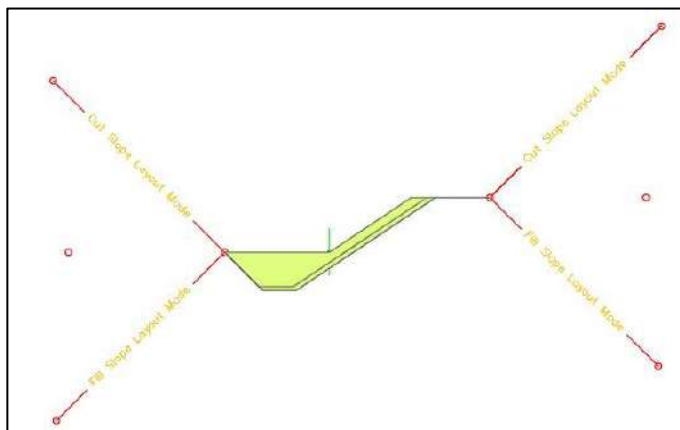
Subensamblaje de enrocado creado en Autodesk Subassembly Composer.
